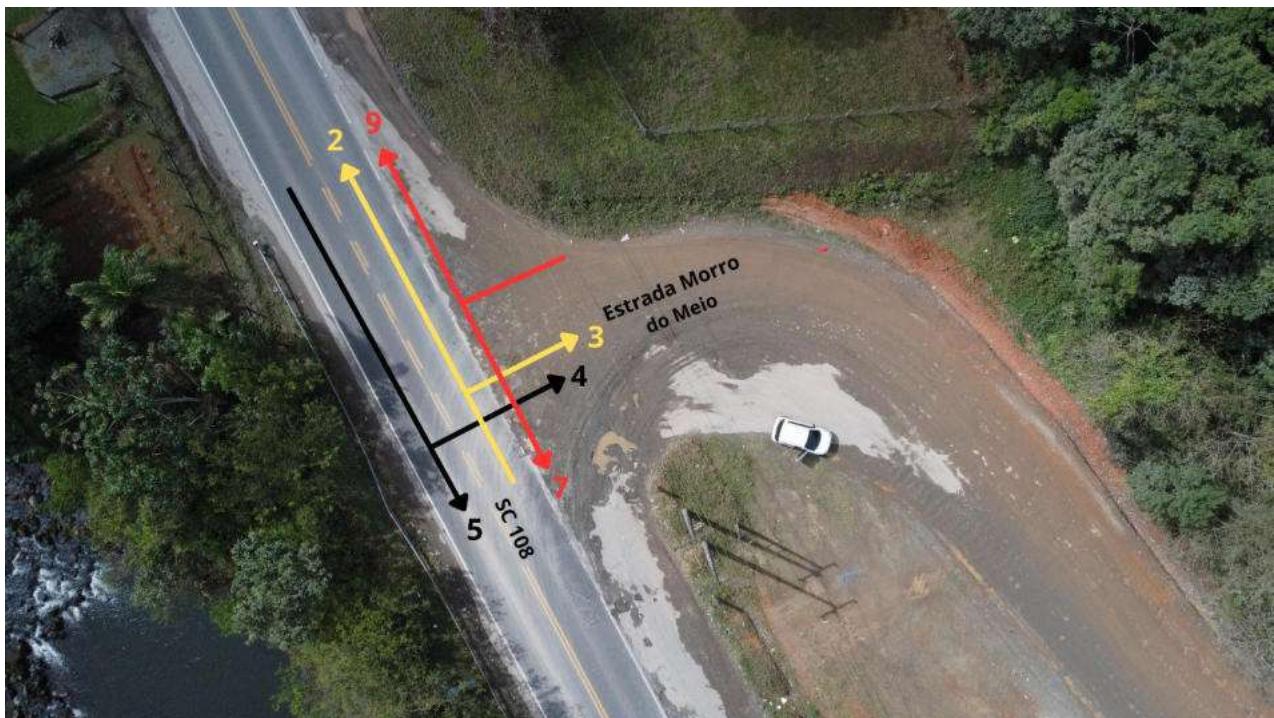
Ponto 1 – Contagem na interseção da Rodovia SC-108 com a Estrada Morro do Meio.
